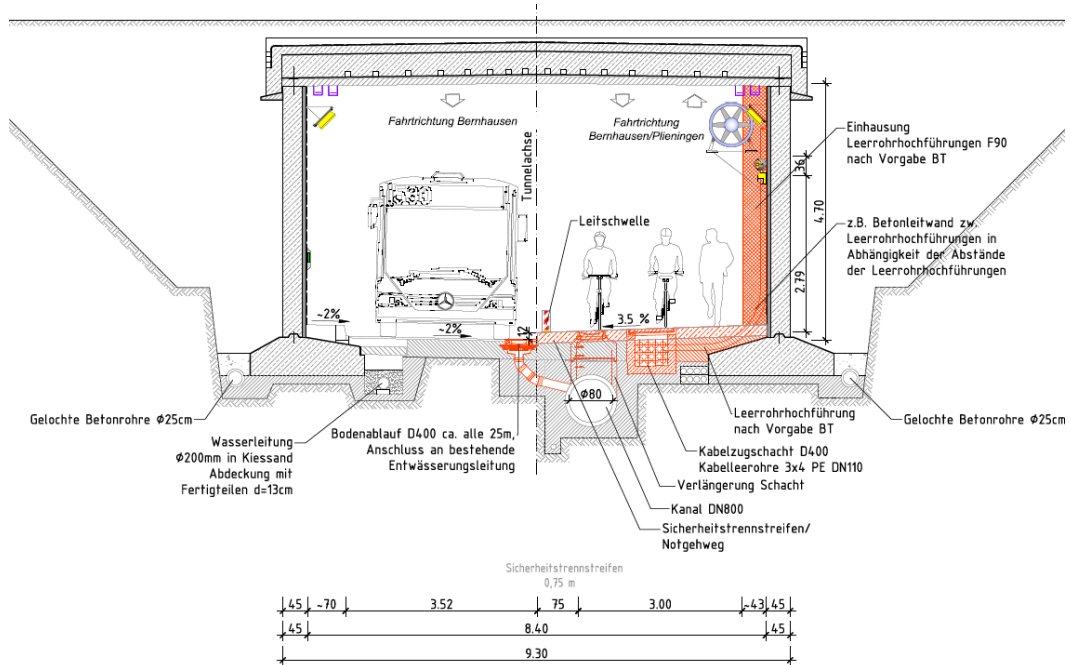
Schematische Querschnittsausbildung Sanierung Bestandstunnel alter Teil – Variante 2.1
